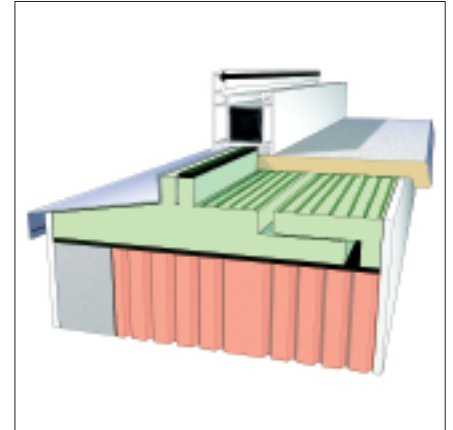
Optimaler unterer Fensteranschluss mit dem illbruck Fensterbankformteil: schlagregendicht, wärmedämmend, luftdicht.
